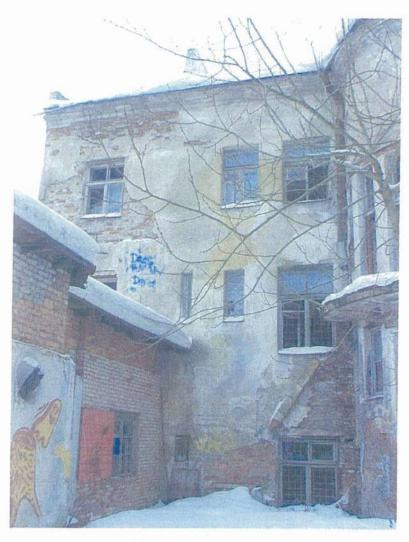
Северо-западный фасад здания. Общий вид с северо-запада.
